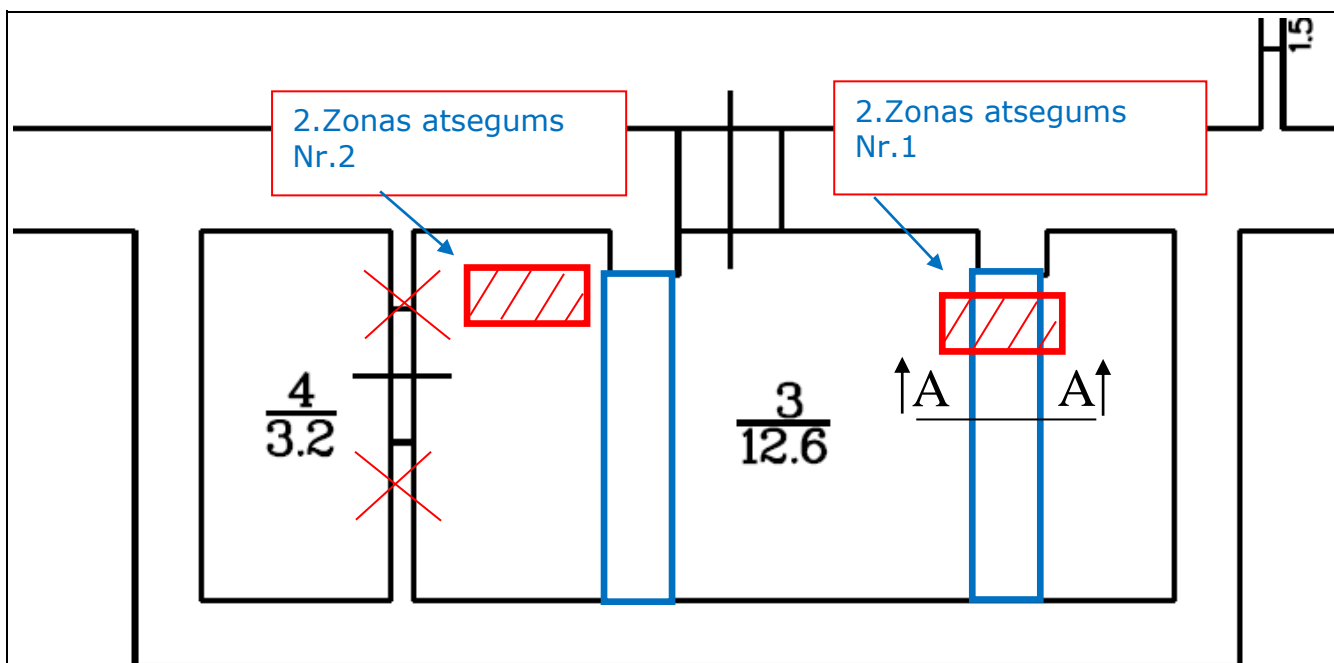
Atseguma vietas telpas Nr.3 pārseguma konstrukcijā.
